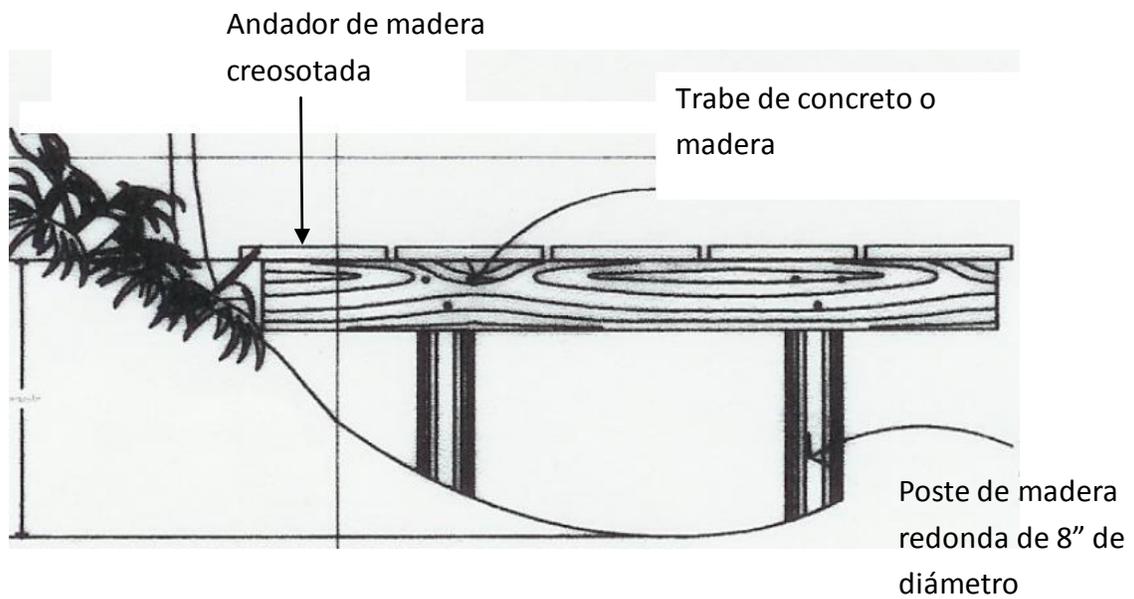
Detalle constructivo del andador del embarcadero. (Fuente: : Adaptada de Bibliocad.com)
